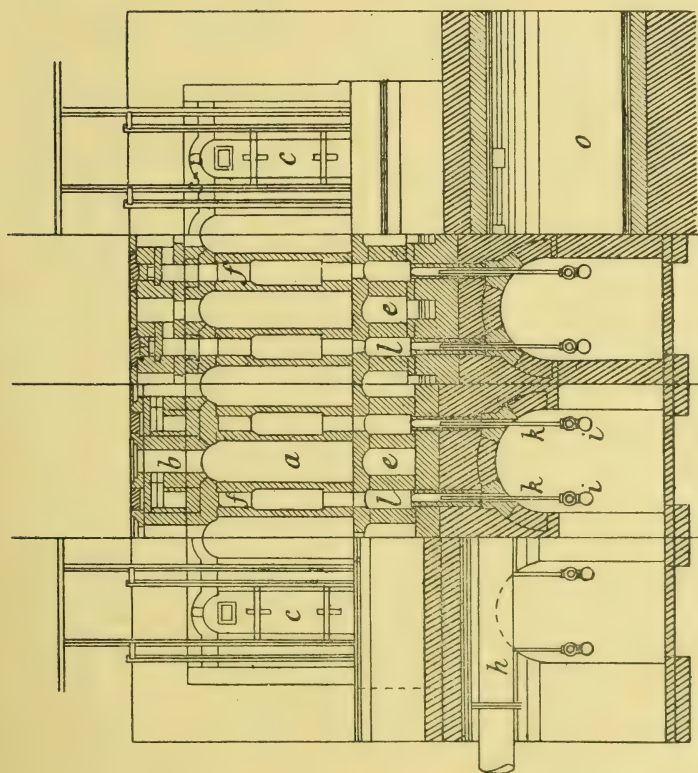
Four OTTO HILGENSTOCK. — Coupe transversale.
